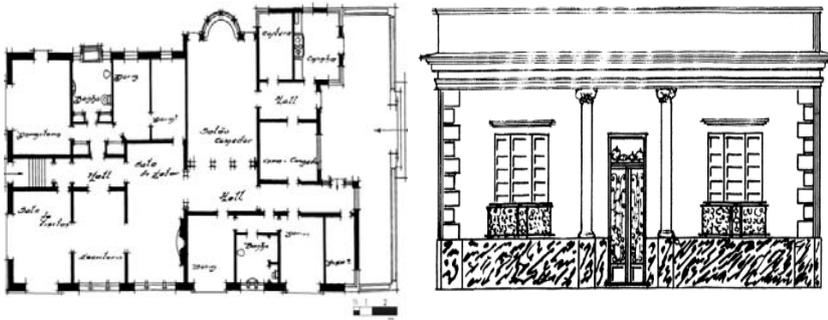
Casa Francisco de Paula Pereira (1943) de Vasco da Gama e Silva. Planta baixa e Fachada.
